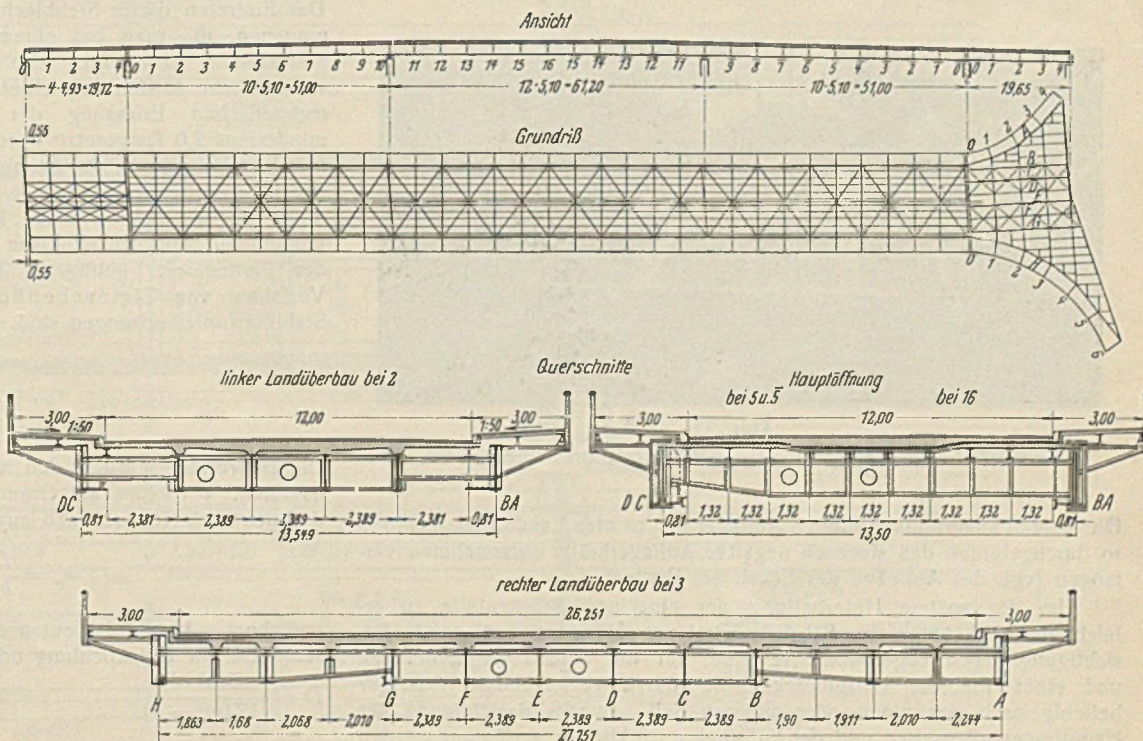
Ansicht, Grundriß und Querschnitte des Stahlüberbaues.
